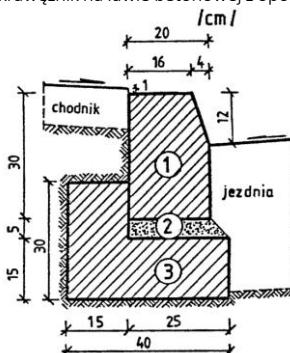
Przykładowe ustawienie krawężników na ławie betonowej
